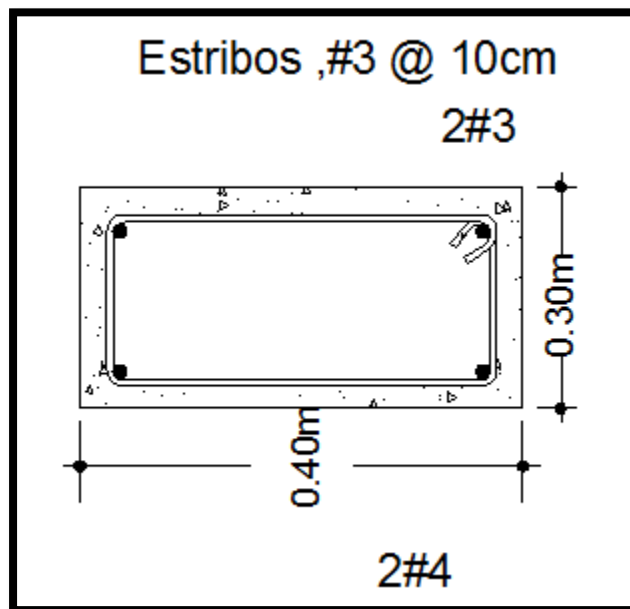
Seccion transversal con distribucion del refuerzo.
